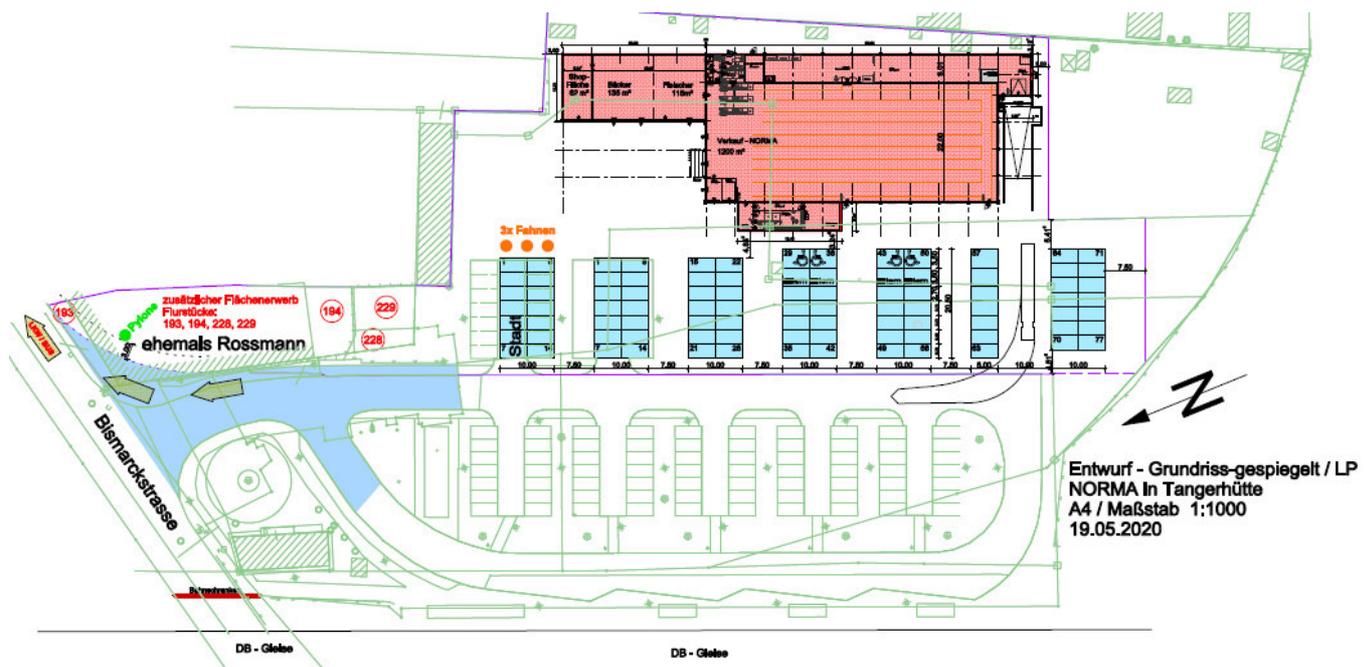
Entwurf Grundriss Flächenkonzept NORMA Tangerhütte bauing-hofer (19.05.2020)
